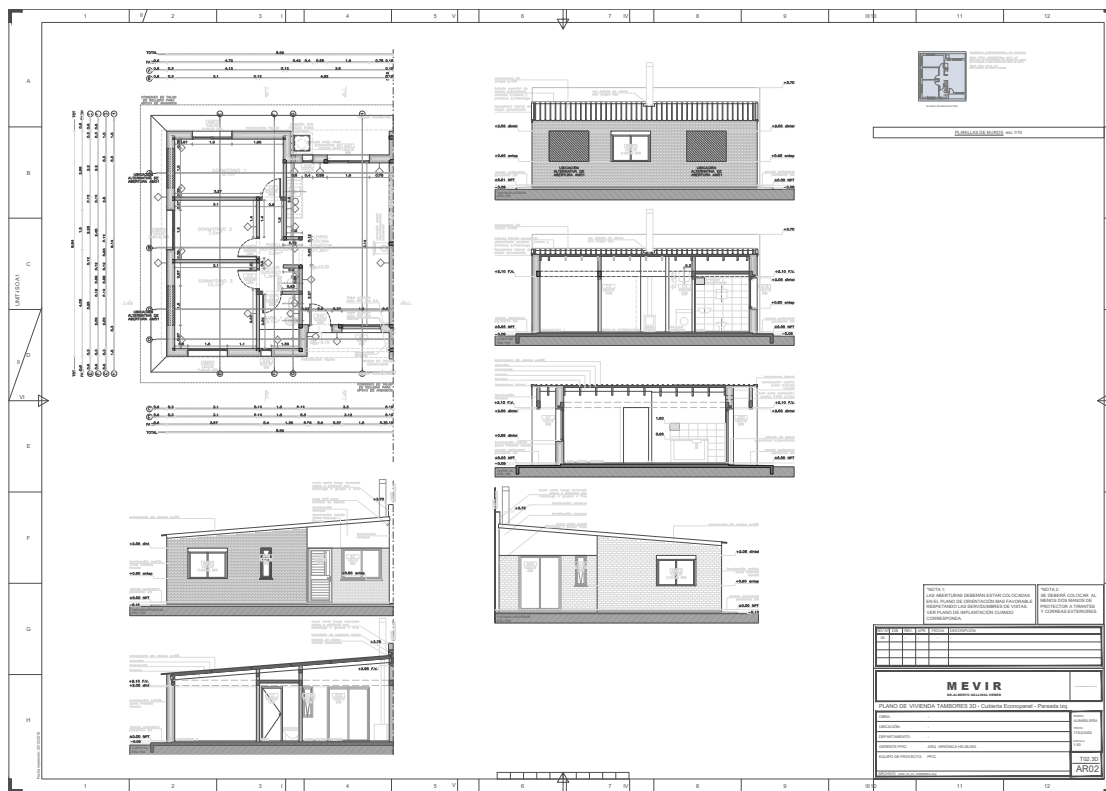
Planos de planta y cortes de MEVIR. Tipología Tambores
